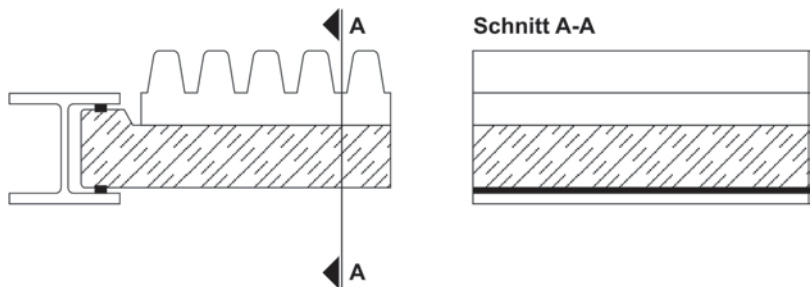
Betonlärmschutzwandelement mit Vorsatzschale
